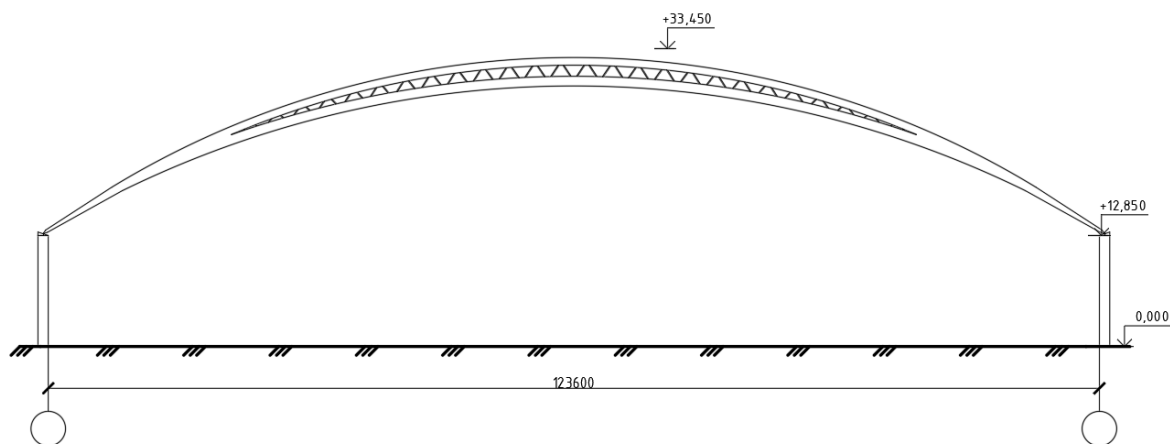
Фрагмент расчетной схемы покрытия
